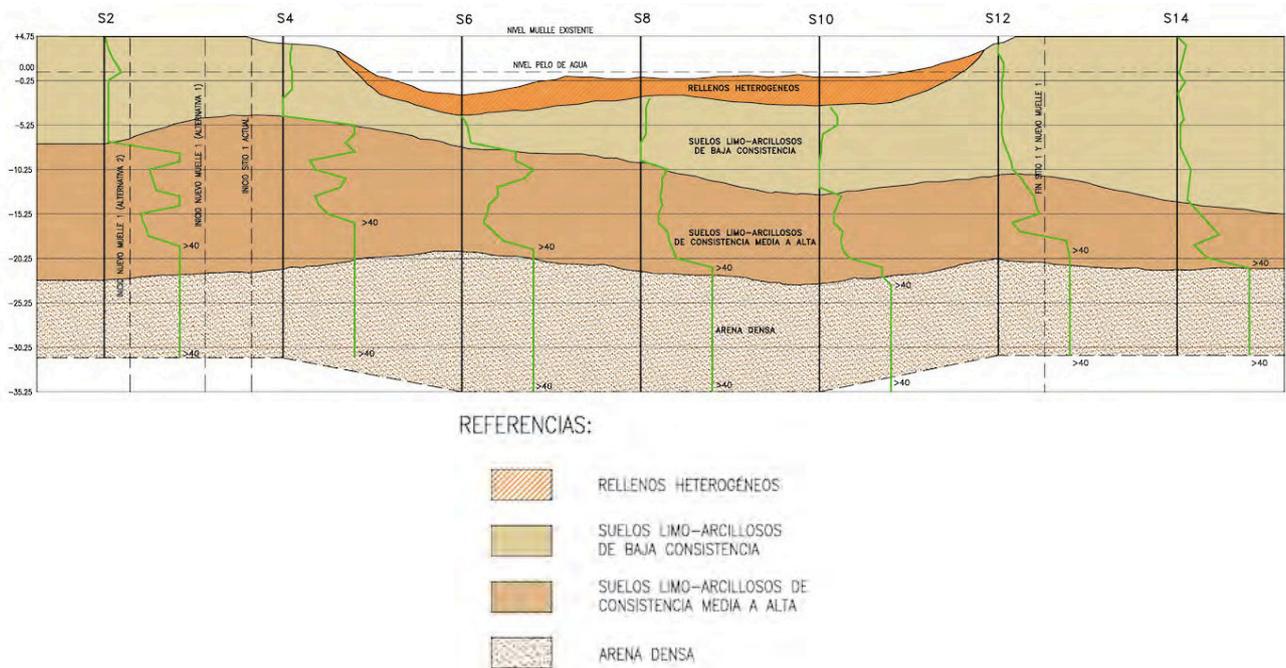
Perfil Geotécnico Sitio 1. Sondeos pares.
